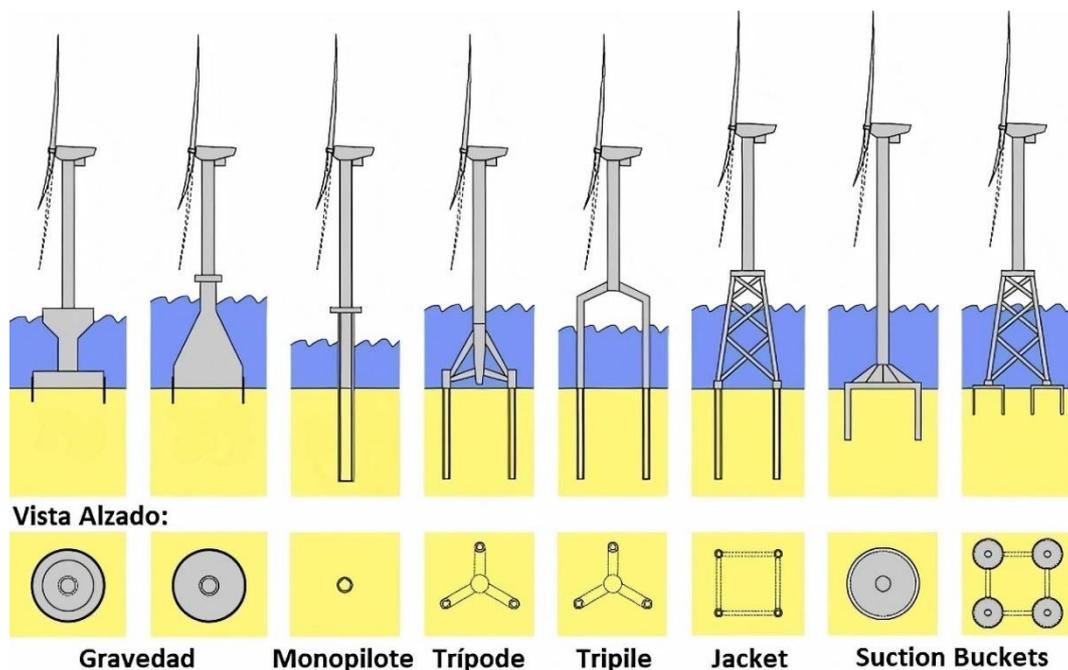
Tecnologías de Cimentación Fija (Adaptado de Staubach & Witchmann, 2020).
